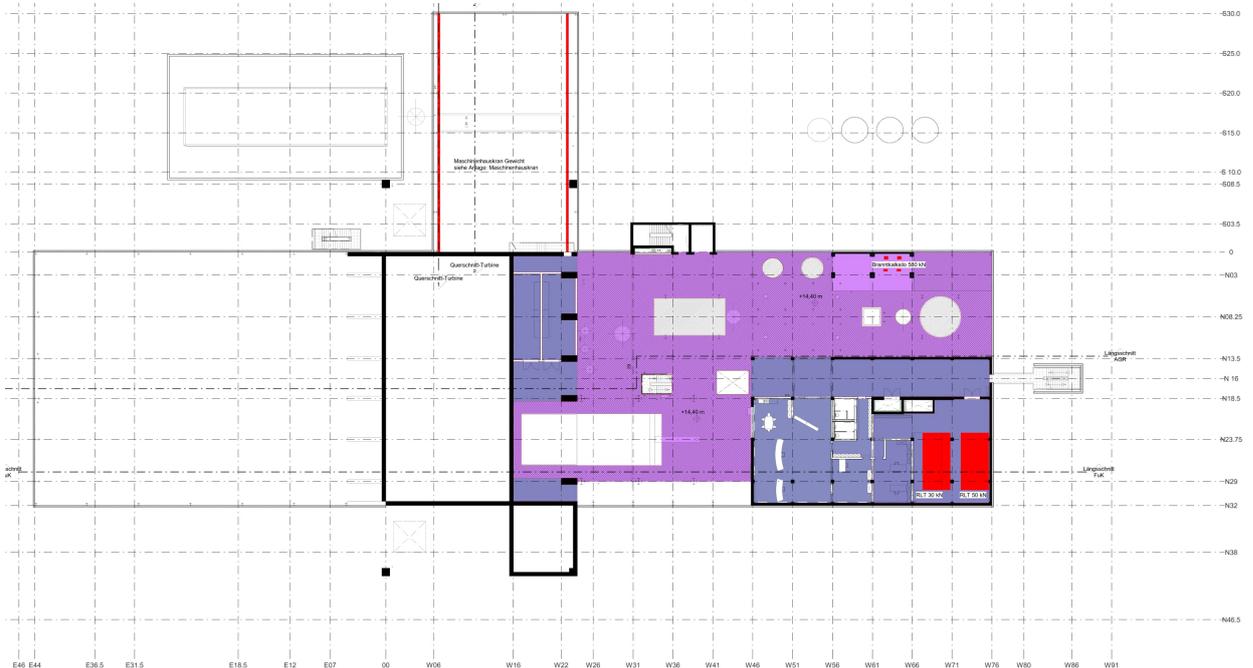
Nutzlasten Grundriss +14.40m
